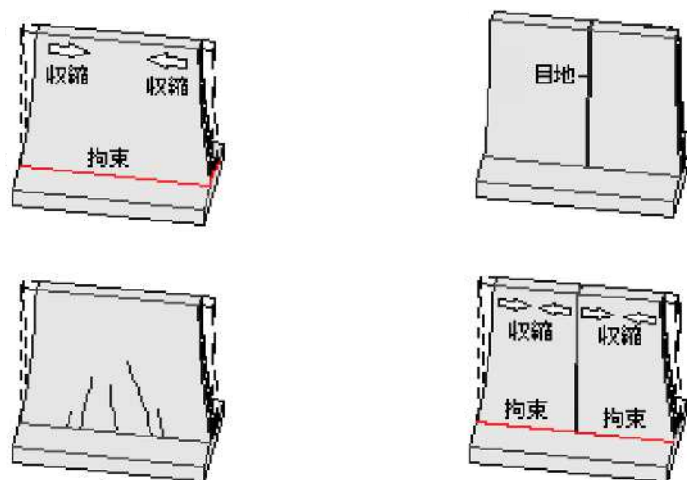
部拘束ひび割れに対する収縮目地の働き
